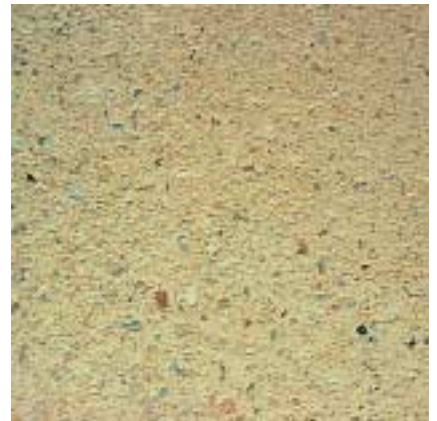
Abgesäuerte Betonoberfläche, heller Zuschlag, weißer Zement
